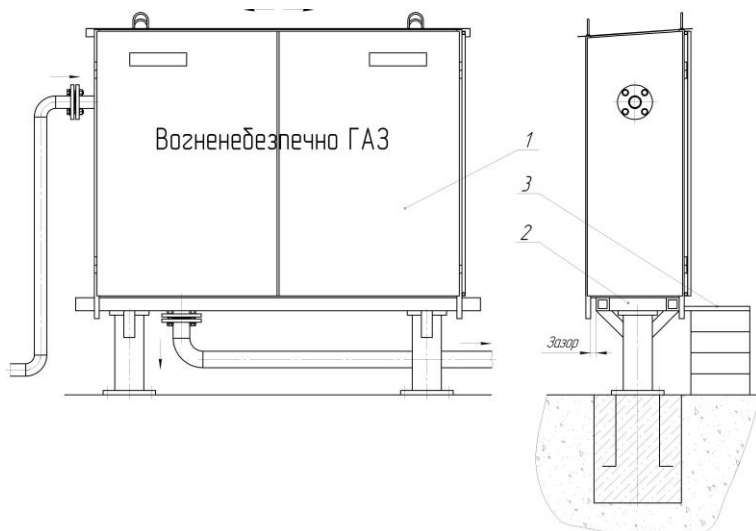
Габаритно-приєднувальна схема газорегуляторного пункту ПГШ М32: а) – з однією або з двома лініями редукування; б) з однією або двома лініями редукування та вбудованим вузлом обліком газу
